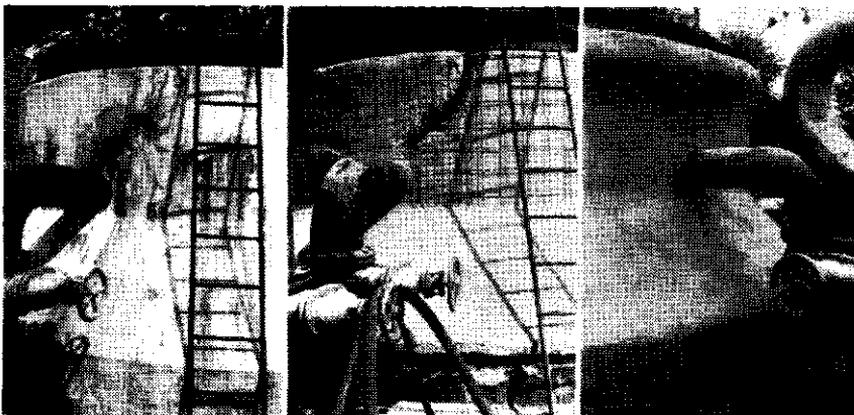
Risse im Beton eines Faulbehälterkopfes.
